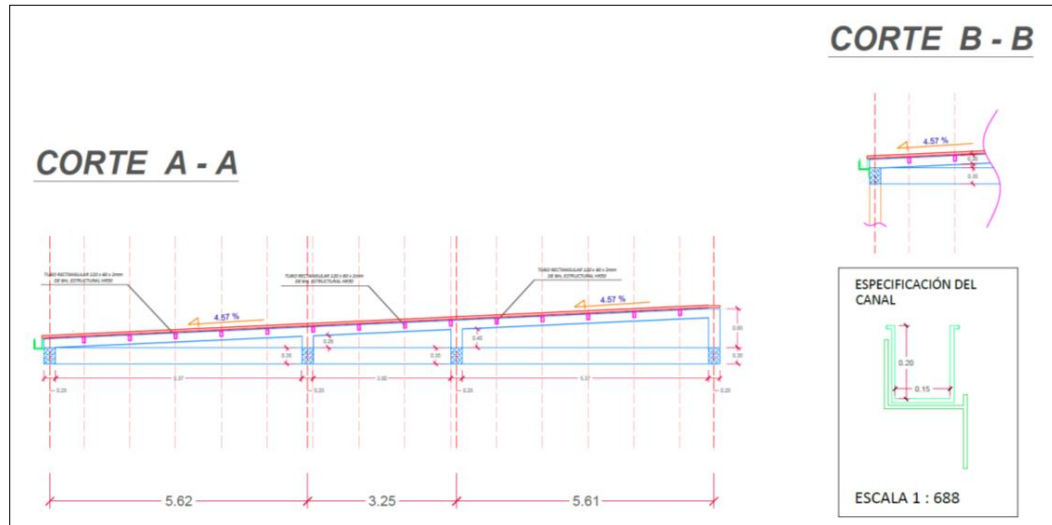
Corte arquitectónico A-A y B-B, de la estructura 1 del Centro Vida.
